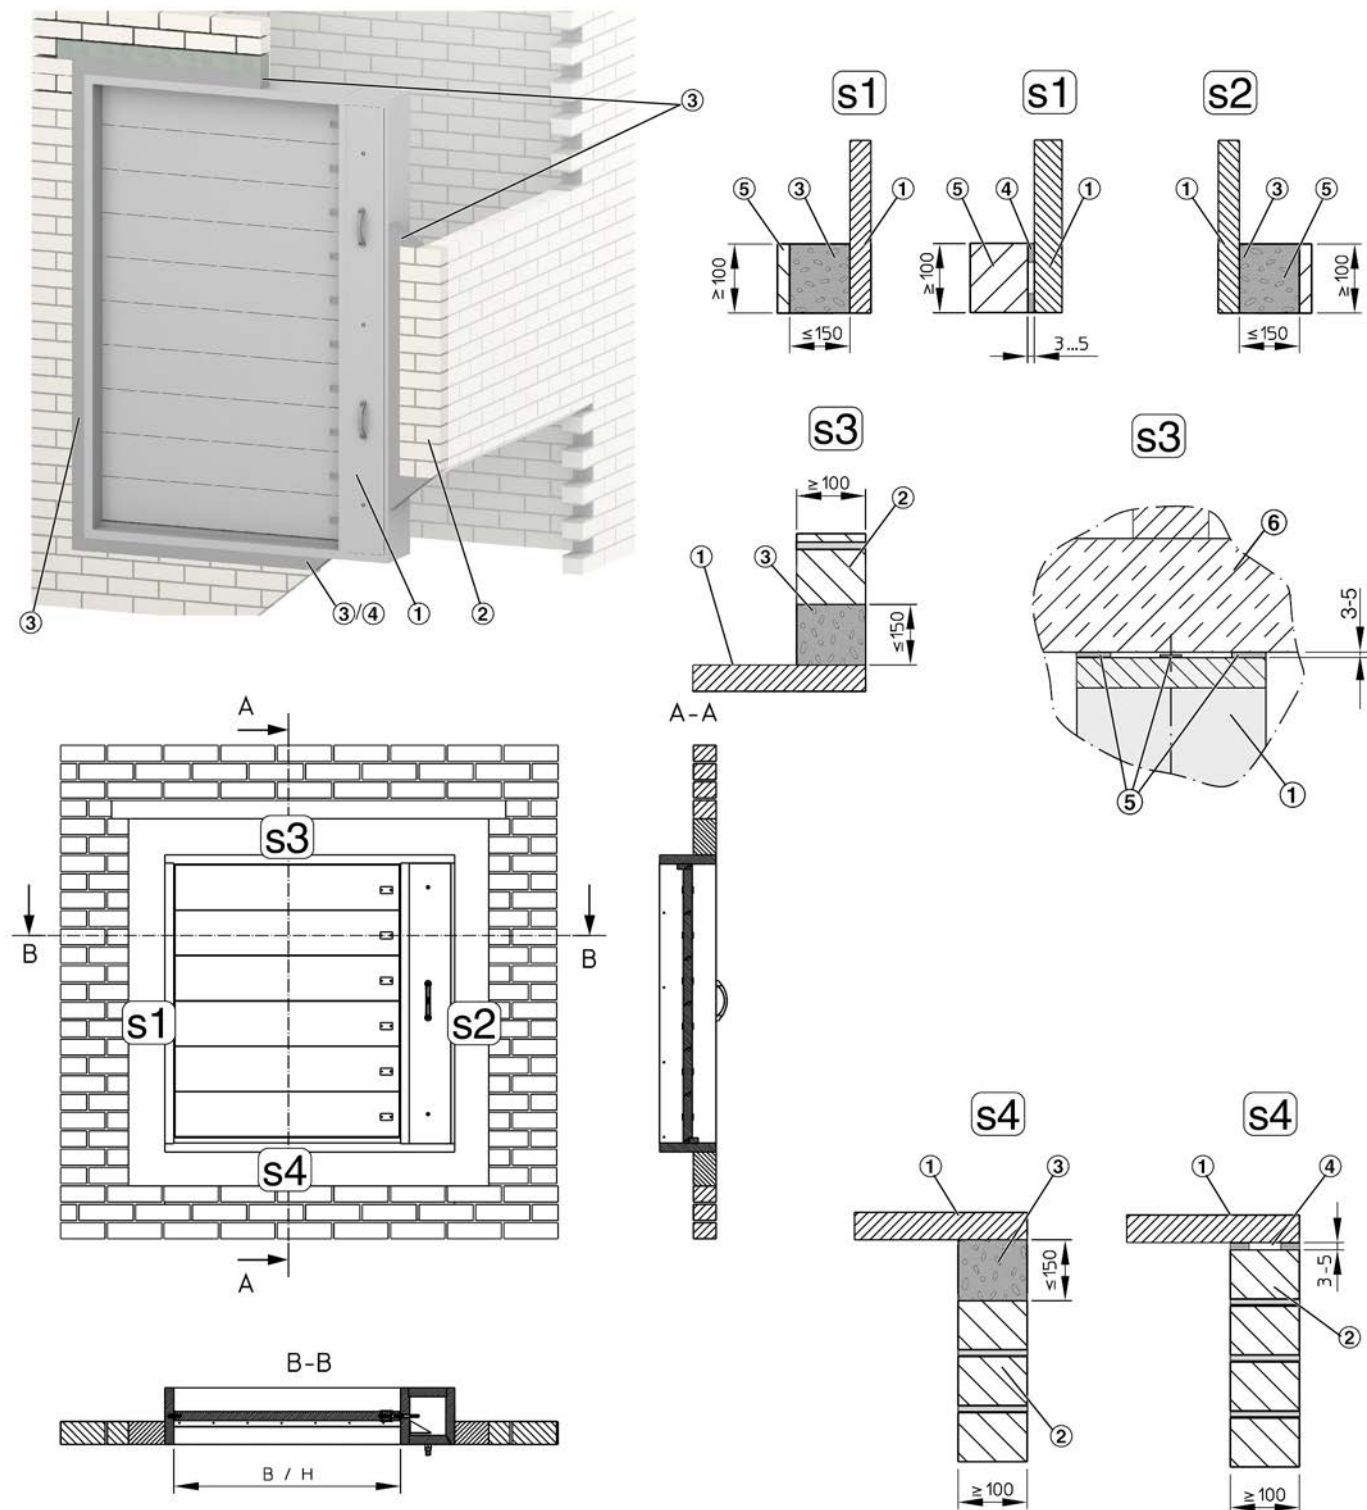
Installazione a base di malta in una parete piena o parete solida cava
